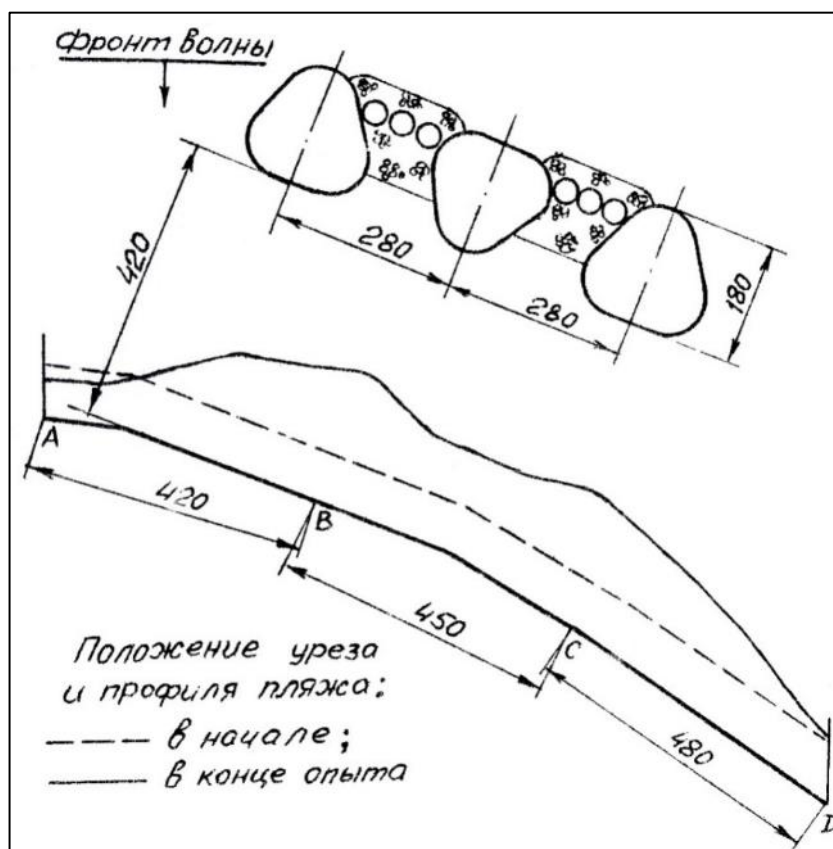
Конструкция в опыте №3 – группа из трех островов с перекрытием проветров отсыпкой из камня
